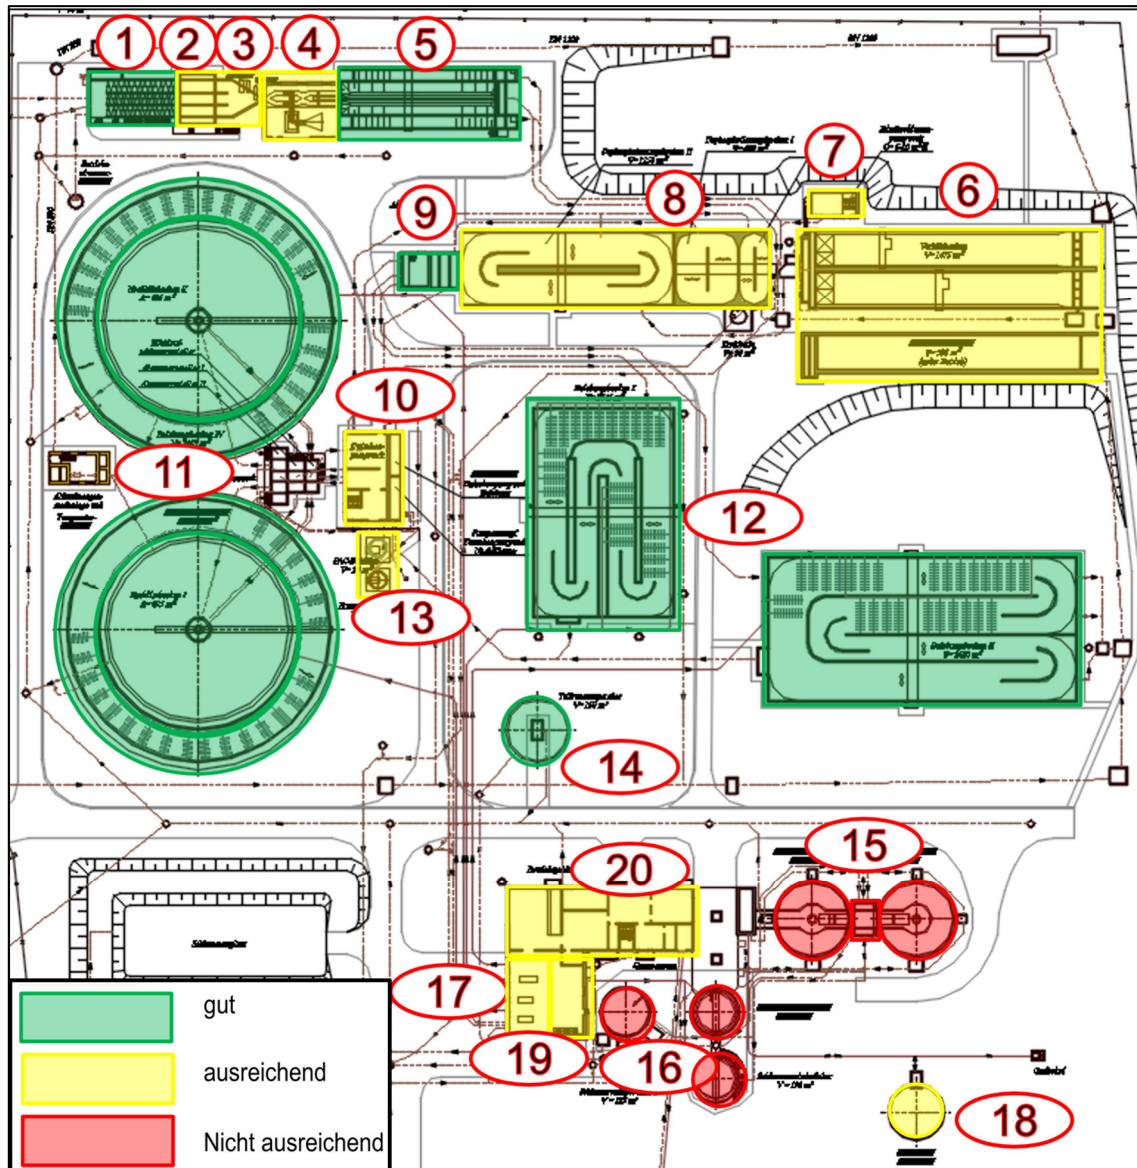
Grafische Lageplandarstellung der Bestandsbewertung Bautechnik
